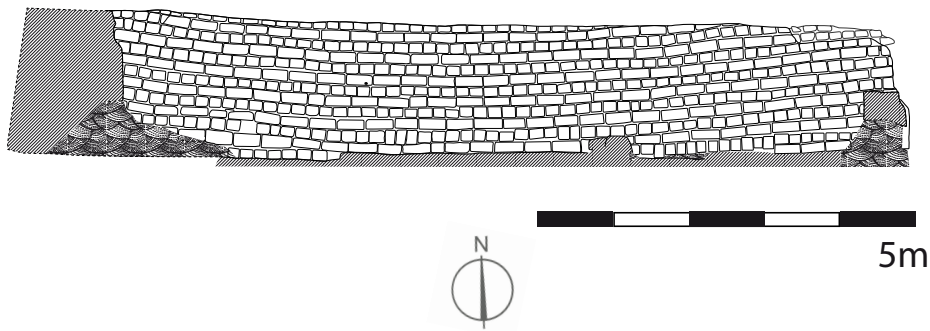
Profil de la façade nord de la maison-tour TG2012.K6 (plan préliminaire)
